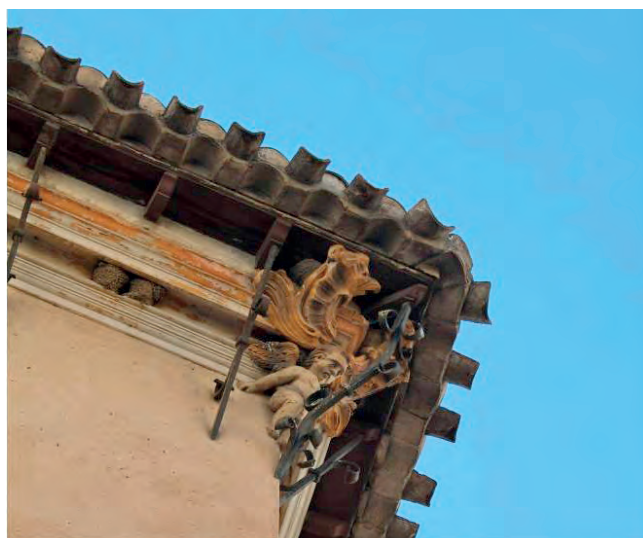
Detalle de esquina con angelote y cubierta de teja.
